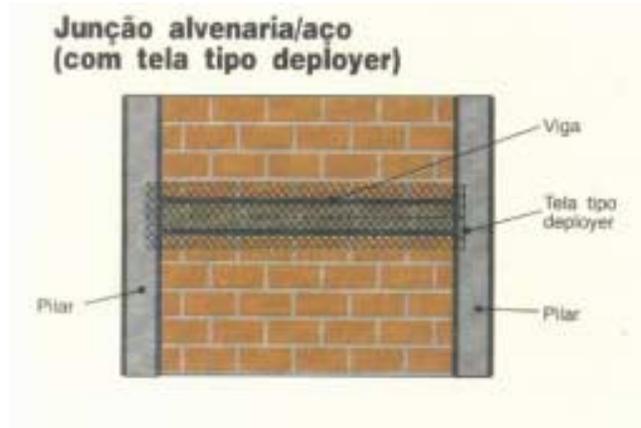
Esquema de construção em alvenaria para estrutura metálica embutida – COSTA²¹
